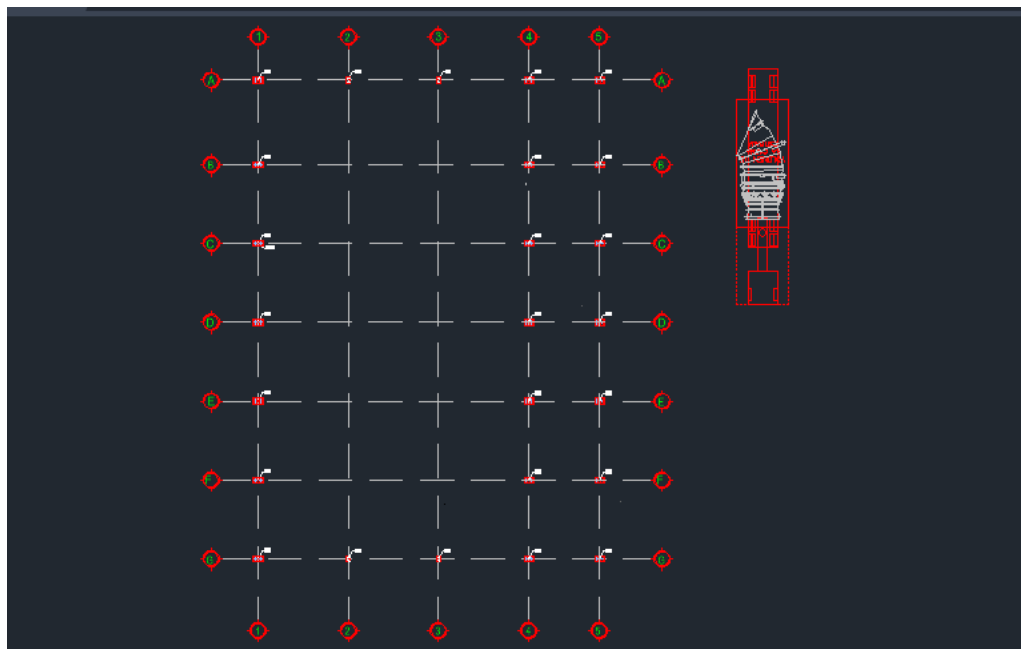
Plano 2D sembrado de columnas mediante Autocad (Disciplina de Estructuras).
